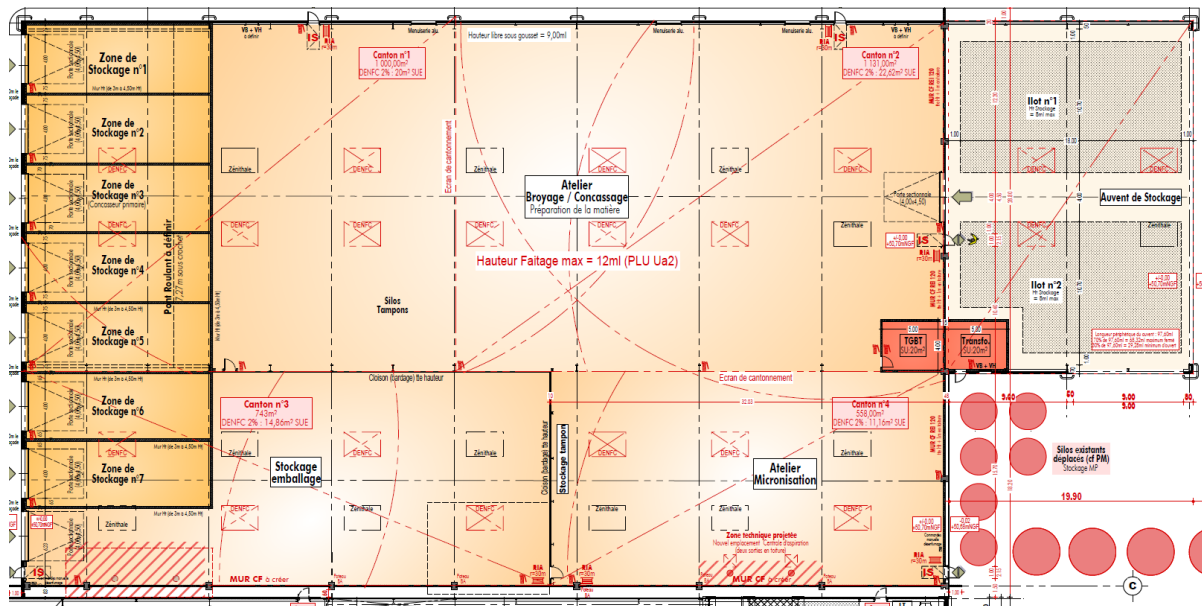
Plan intérieur du futur local broyage (Source : Nicot Architecte)
